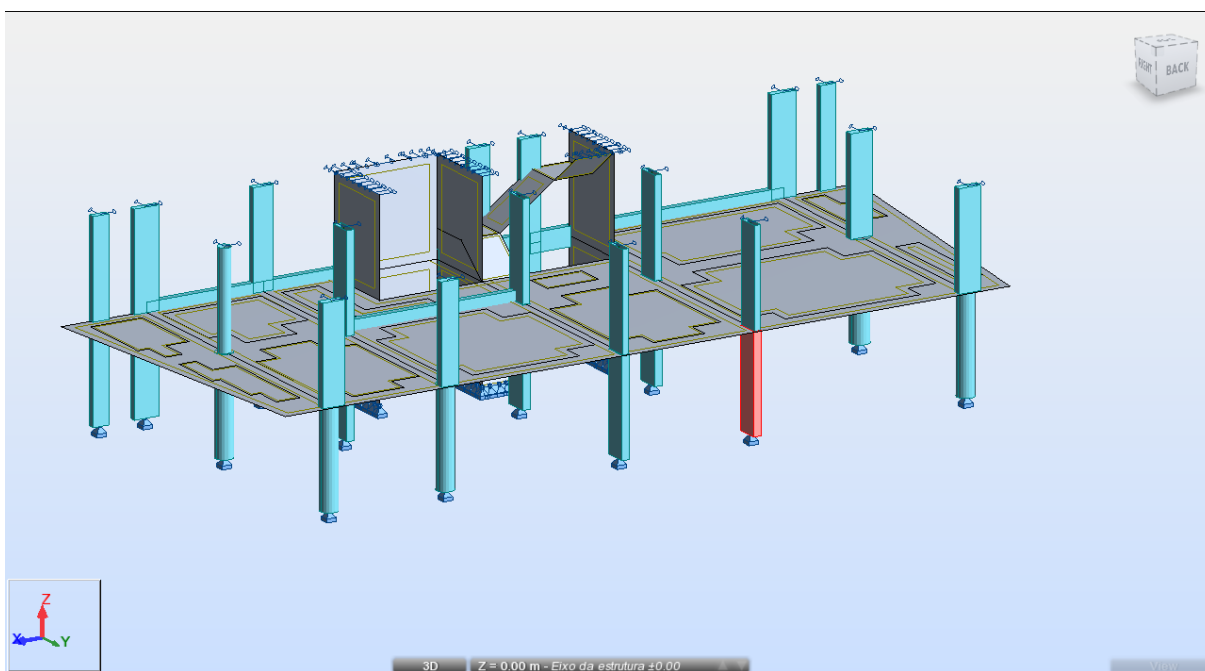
Pilar considerado para o cálculo da armadura de punçoamento
